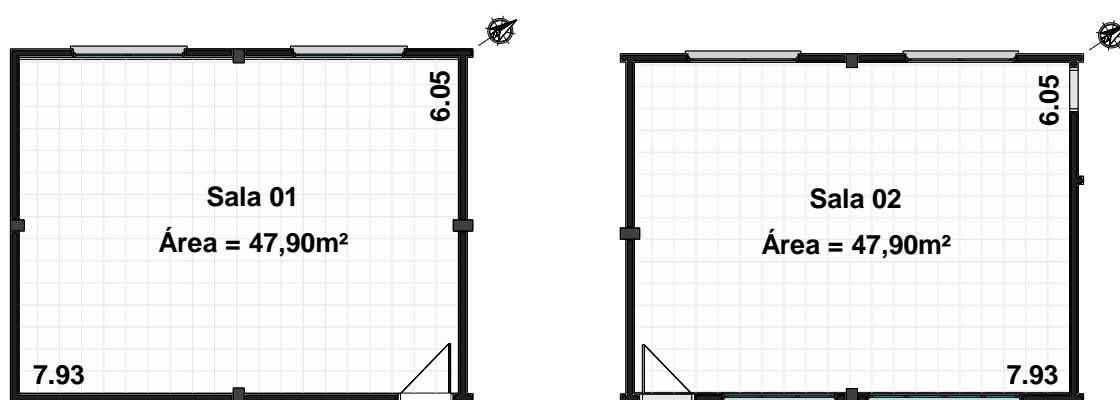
Plantas baixas das salas 01 e 02, respectivamente.
